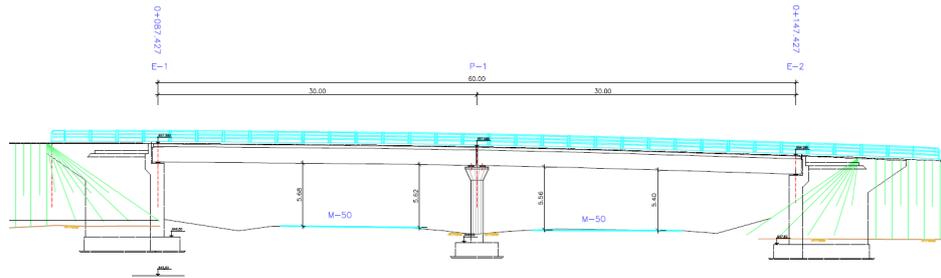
Sección constructiva propuesta para el puente sobre la M50.
